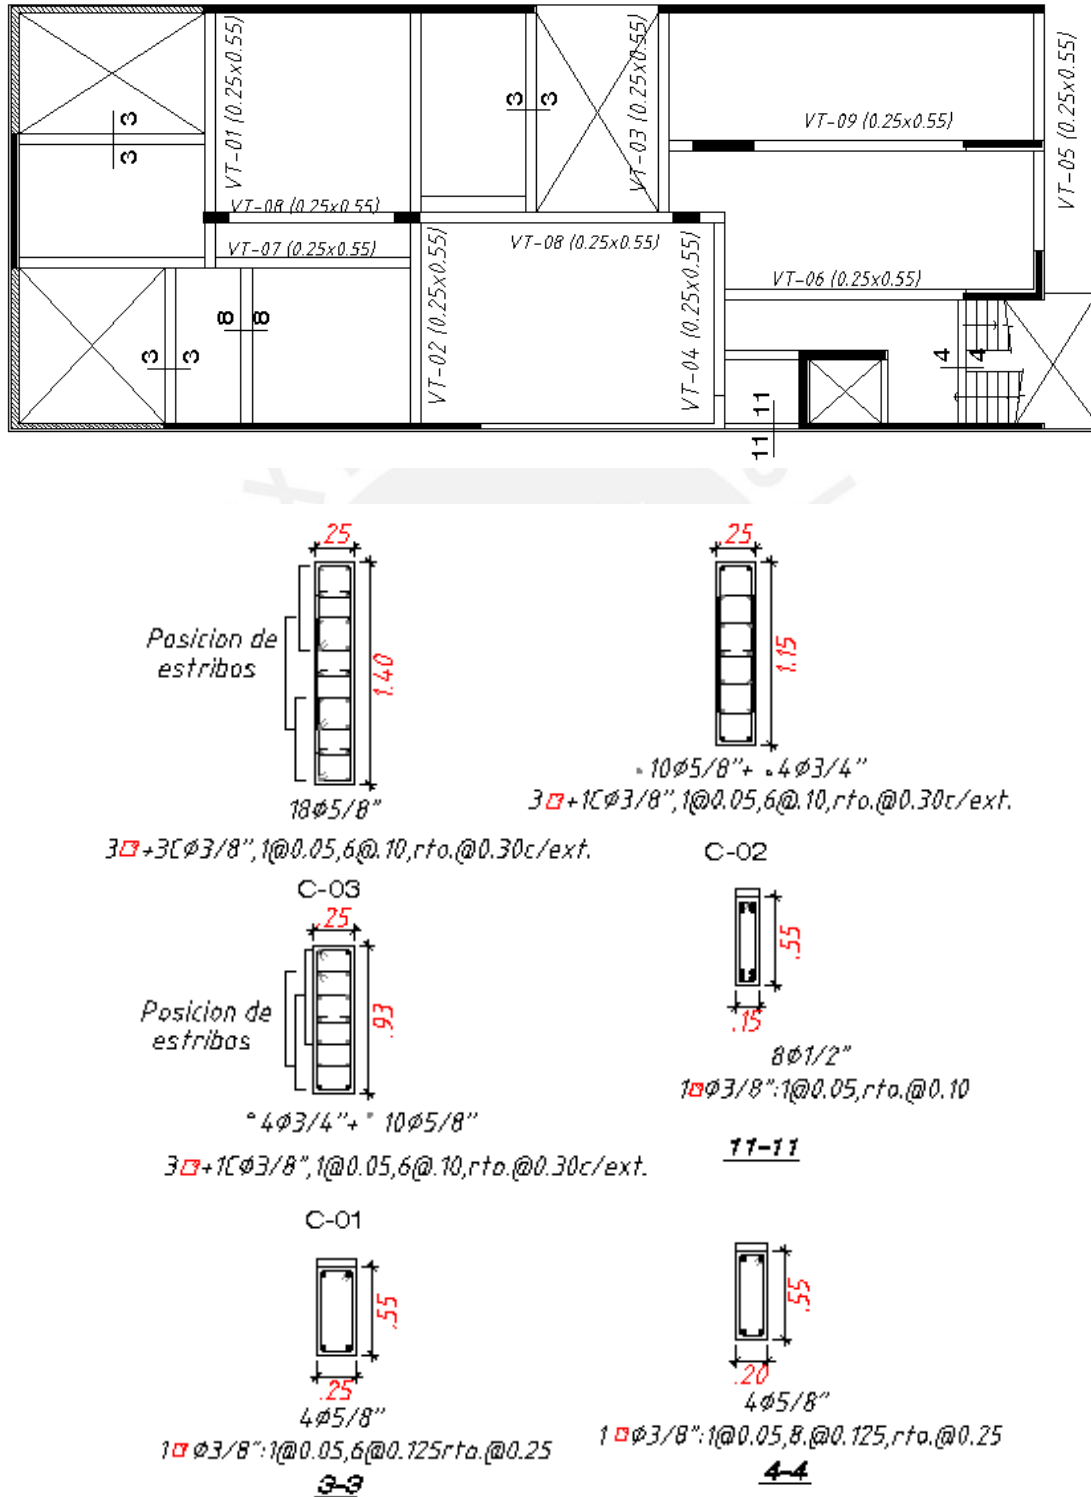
Vigas y columnas en la edificación a analizar.
